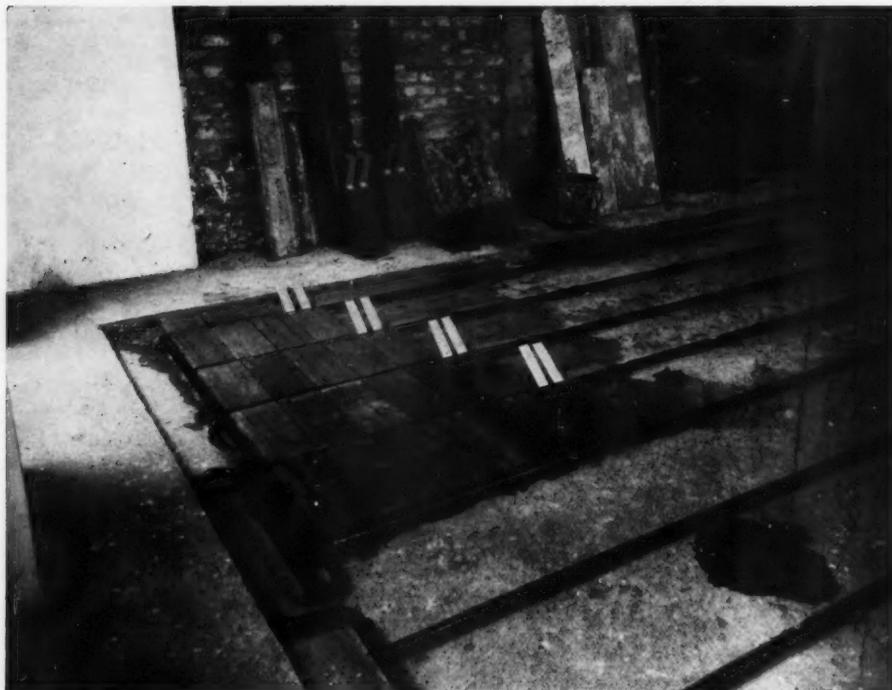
PLANCHER CHAUFFANT EN COURS DE CONSTRUCTION
